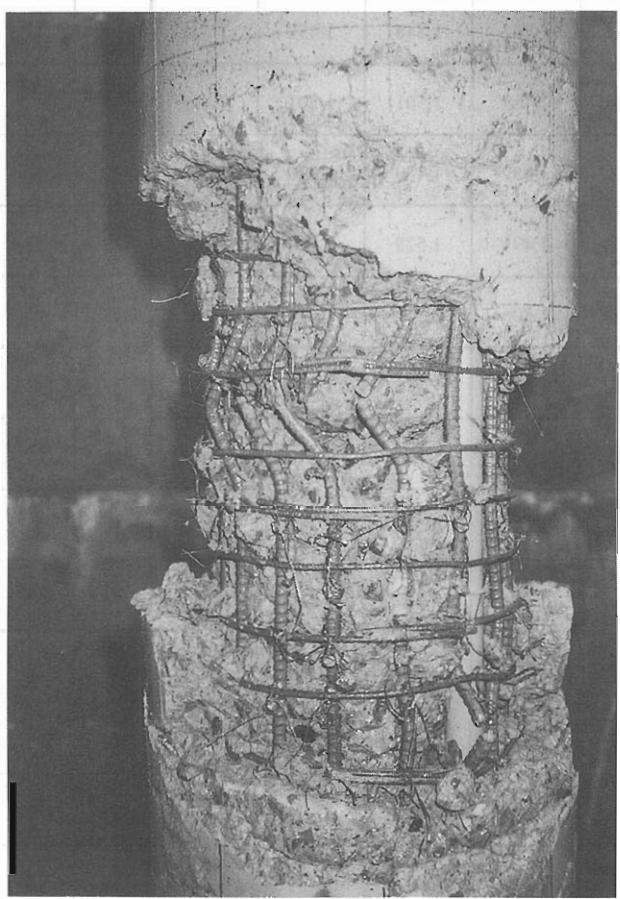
桧体損傷状況④（ケース5：鉄筋コンクリート桧コンクリート除去後）
